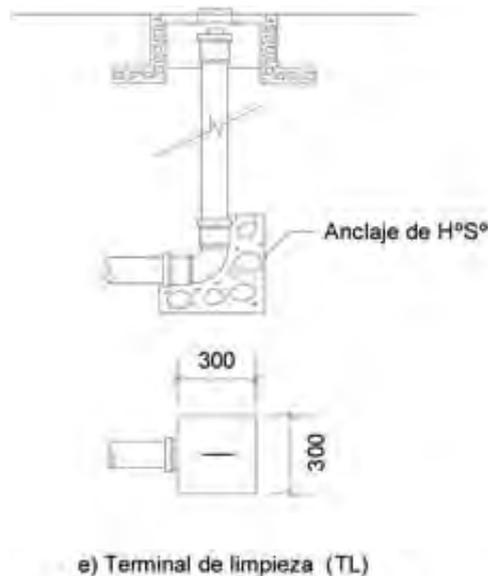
Elementos de inspección. Alcantarillado sanitario condominial
